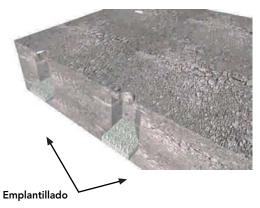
10 : Emplantillado típico de 10 cm bajo el pilote de madera impregnado, rollizo de 9" a 10", solución de fundación aislada.
